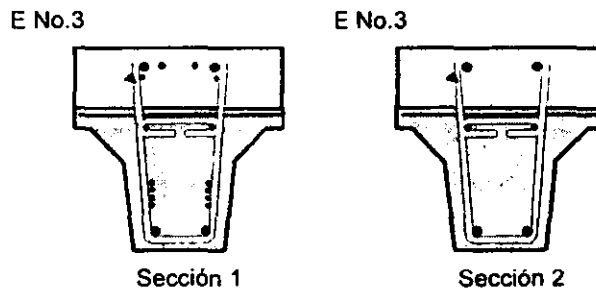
Refuerzo para fuerza cortante en las vigas de rigidez
